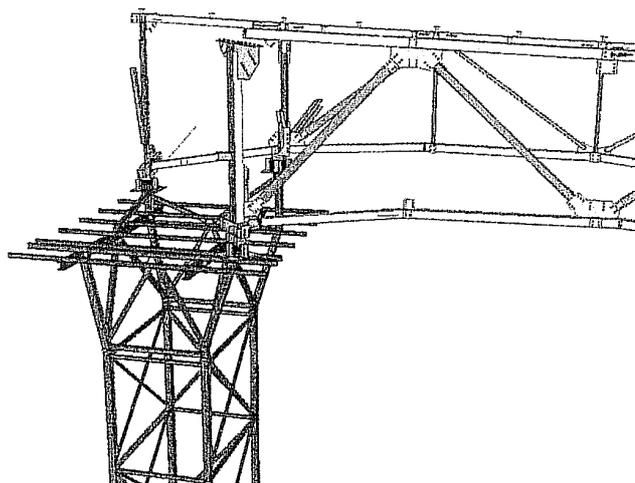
Montagehilfsturm mit teilweise montierter Dachkonstruktion
